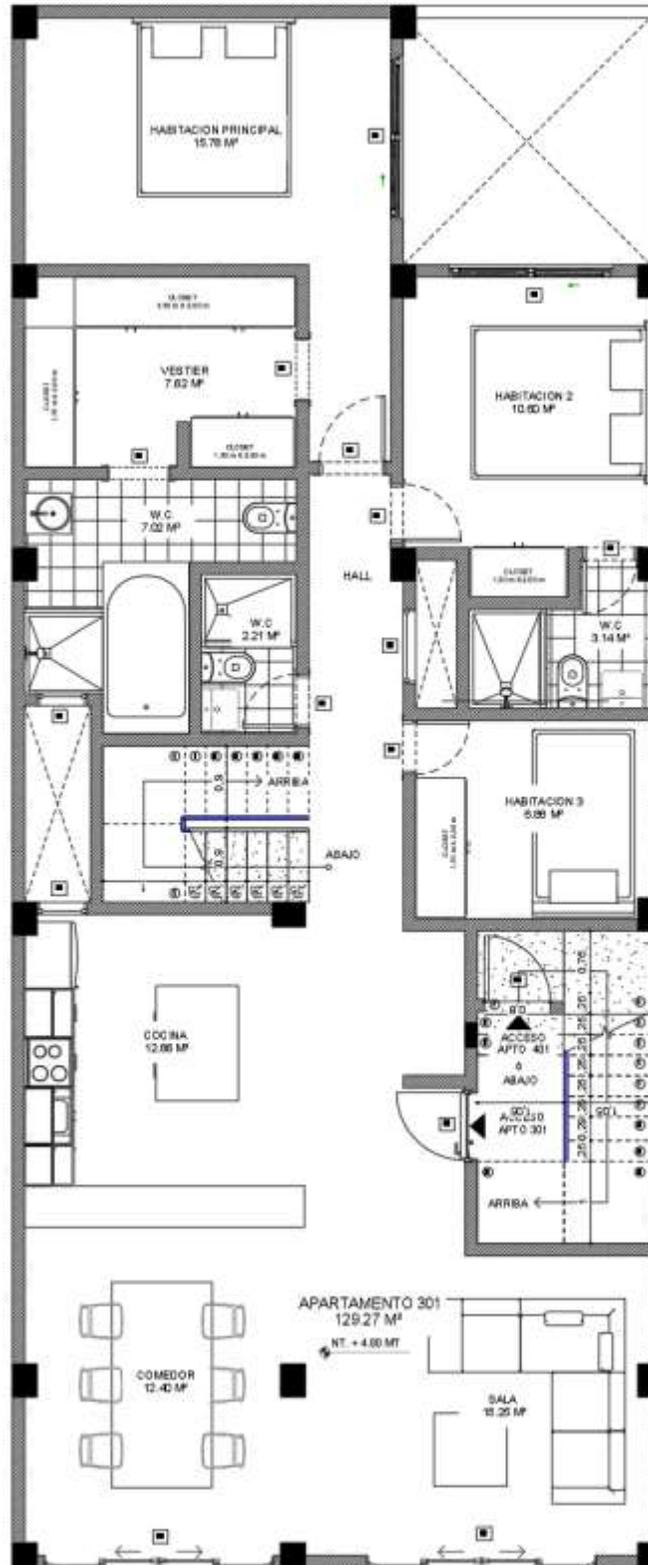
Plano arquitectónico Nivel 3 - Adoptado de: Reconstrucciones.
